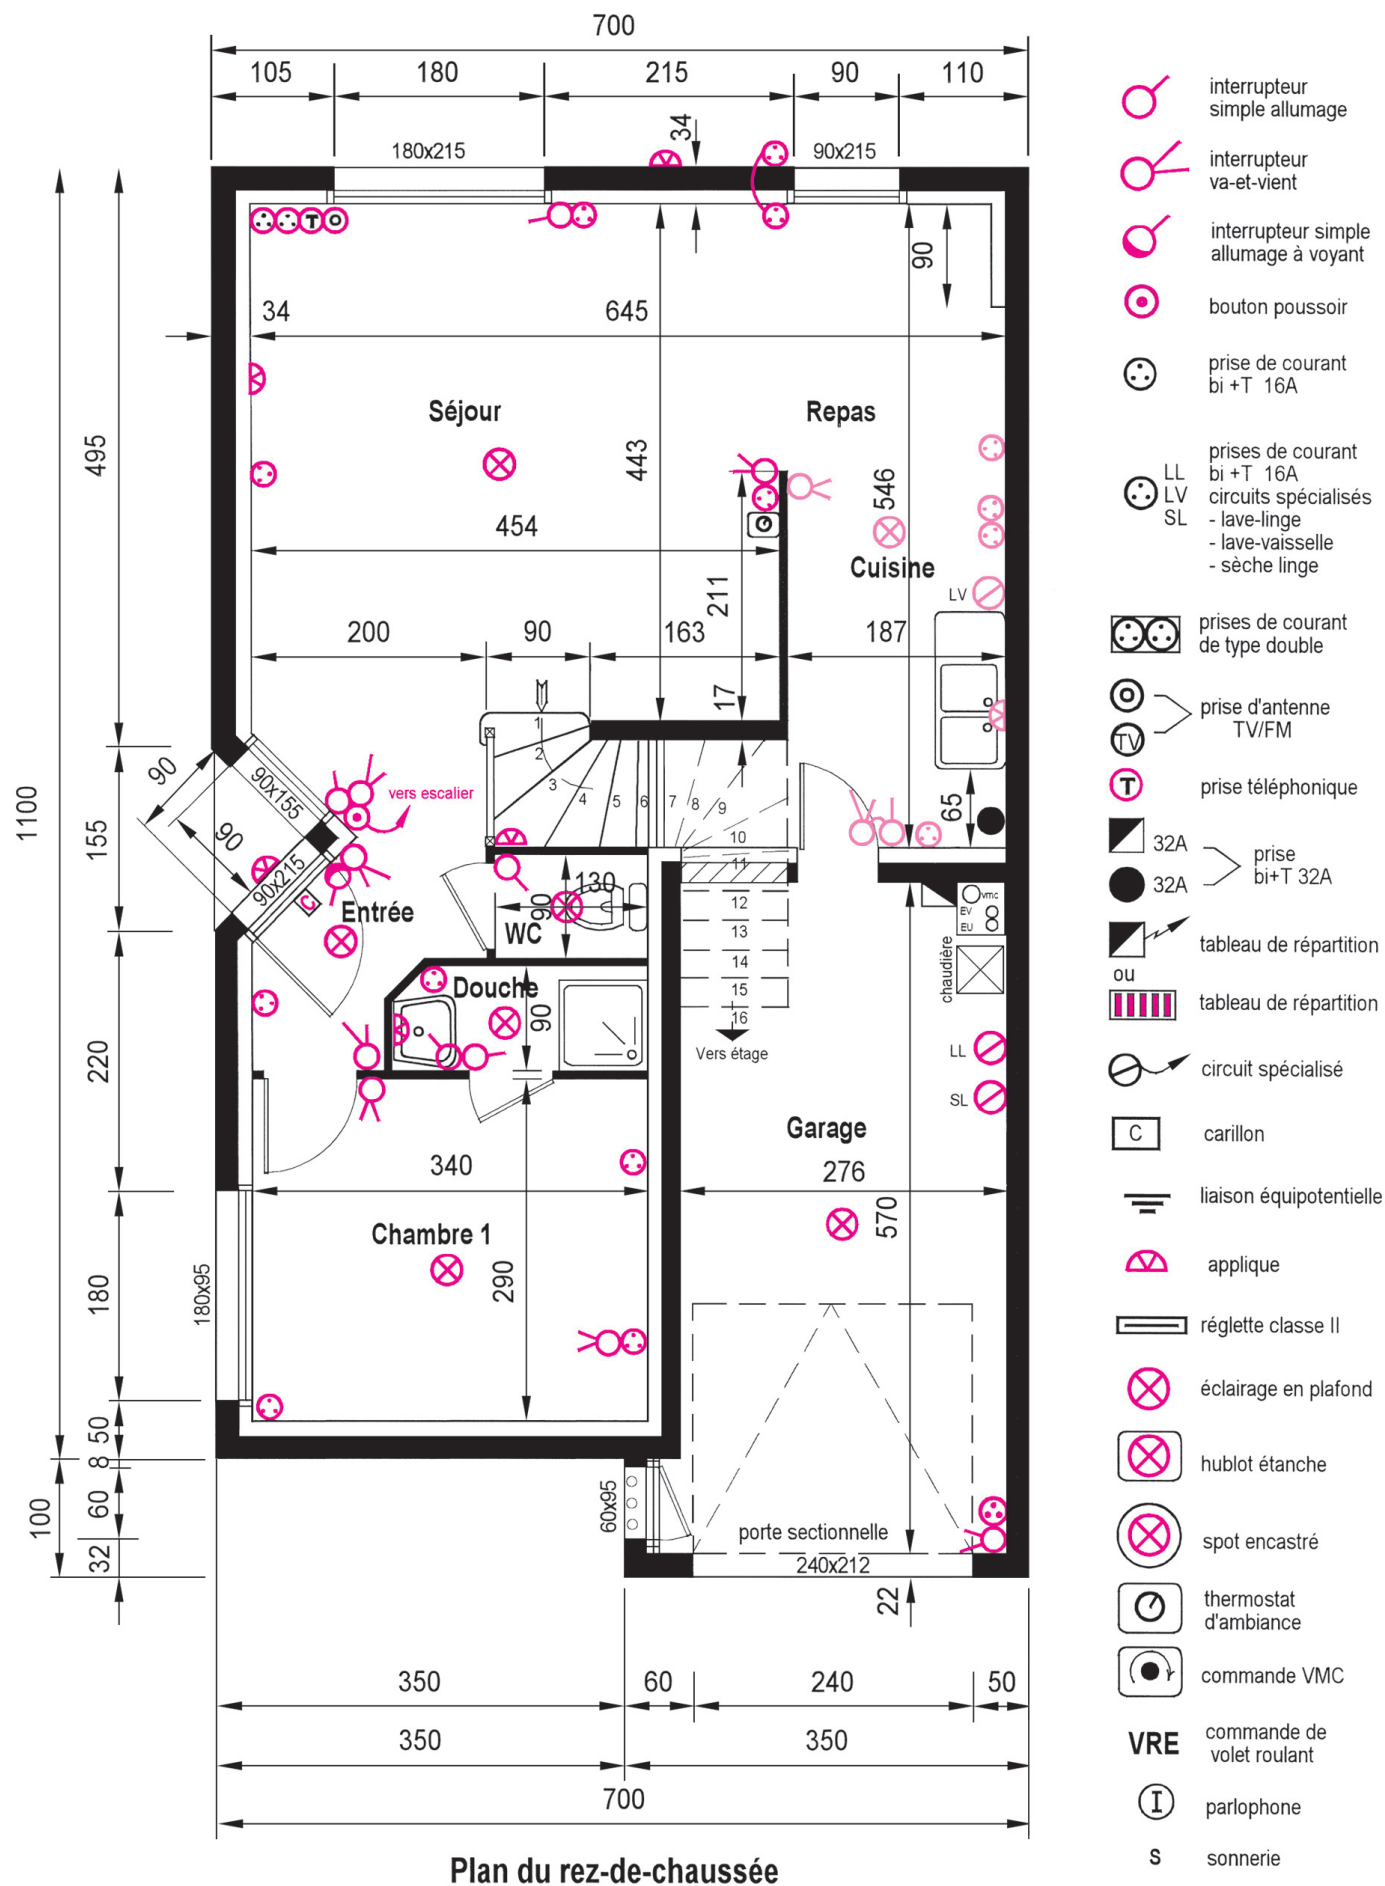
Plan d'appareillage du rez-de-chaussée suivant les prescriptions réglementaires (cf. fig. 24 et 32)
